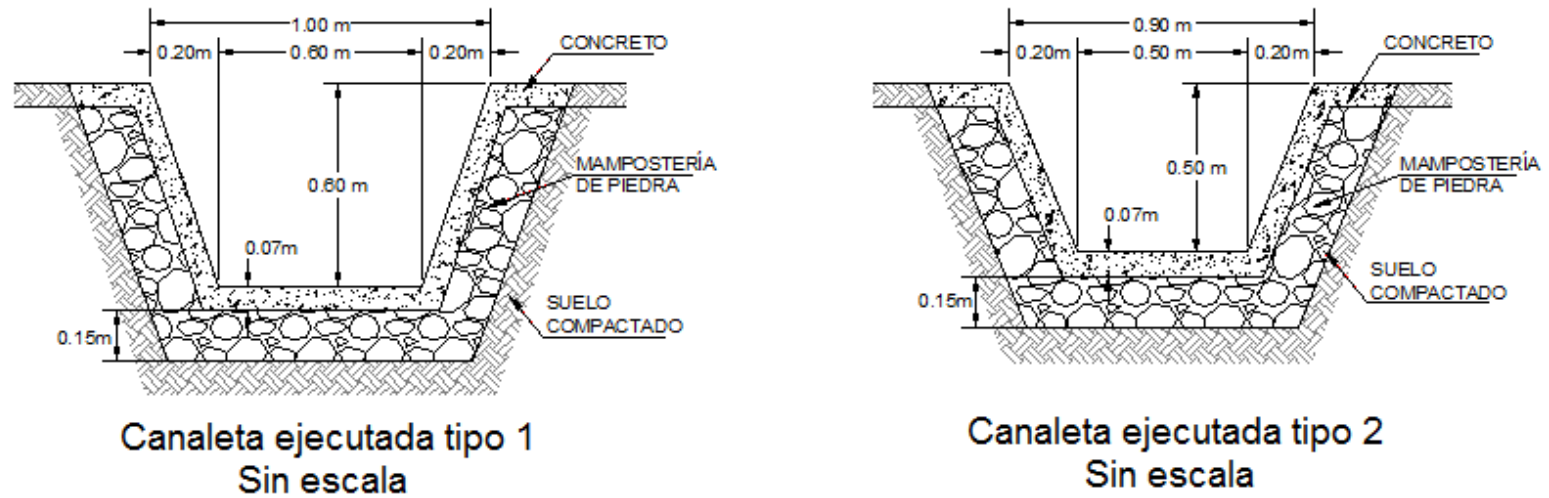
Sección transversal de canaletas ejecutadas en el proyecto
